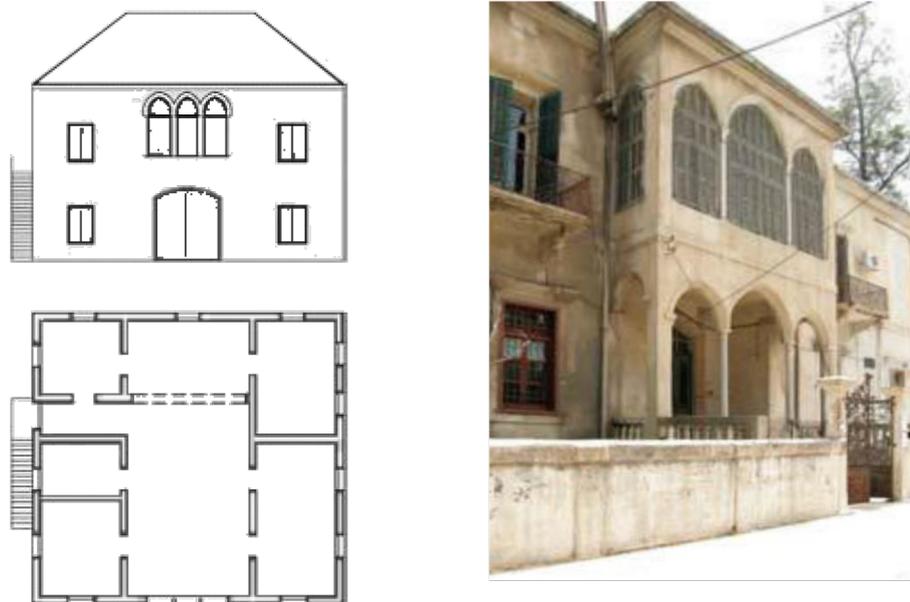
Das Haus mit zentraler Halle/Das libanesische Haus - Grundriss, Ansicht & Bild
